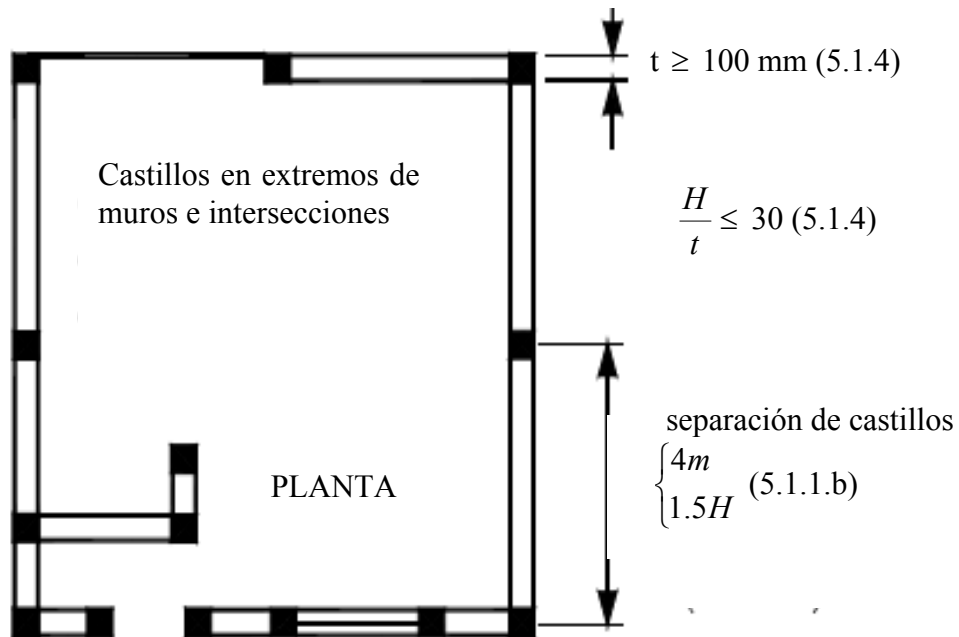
Muros de mampostería confinada en el plano (ibid).
